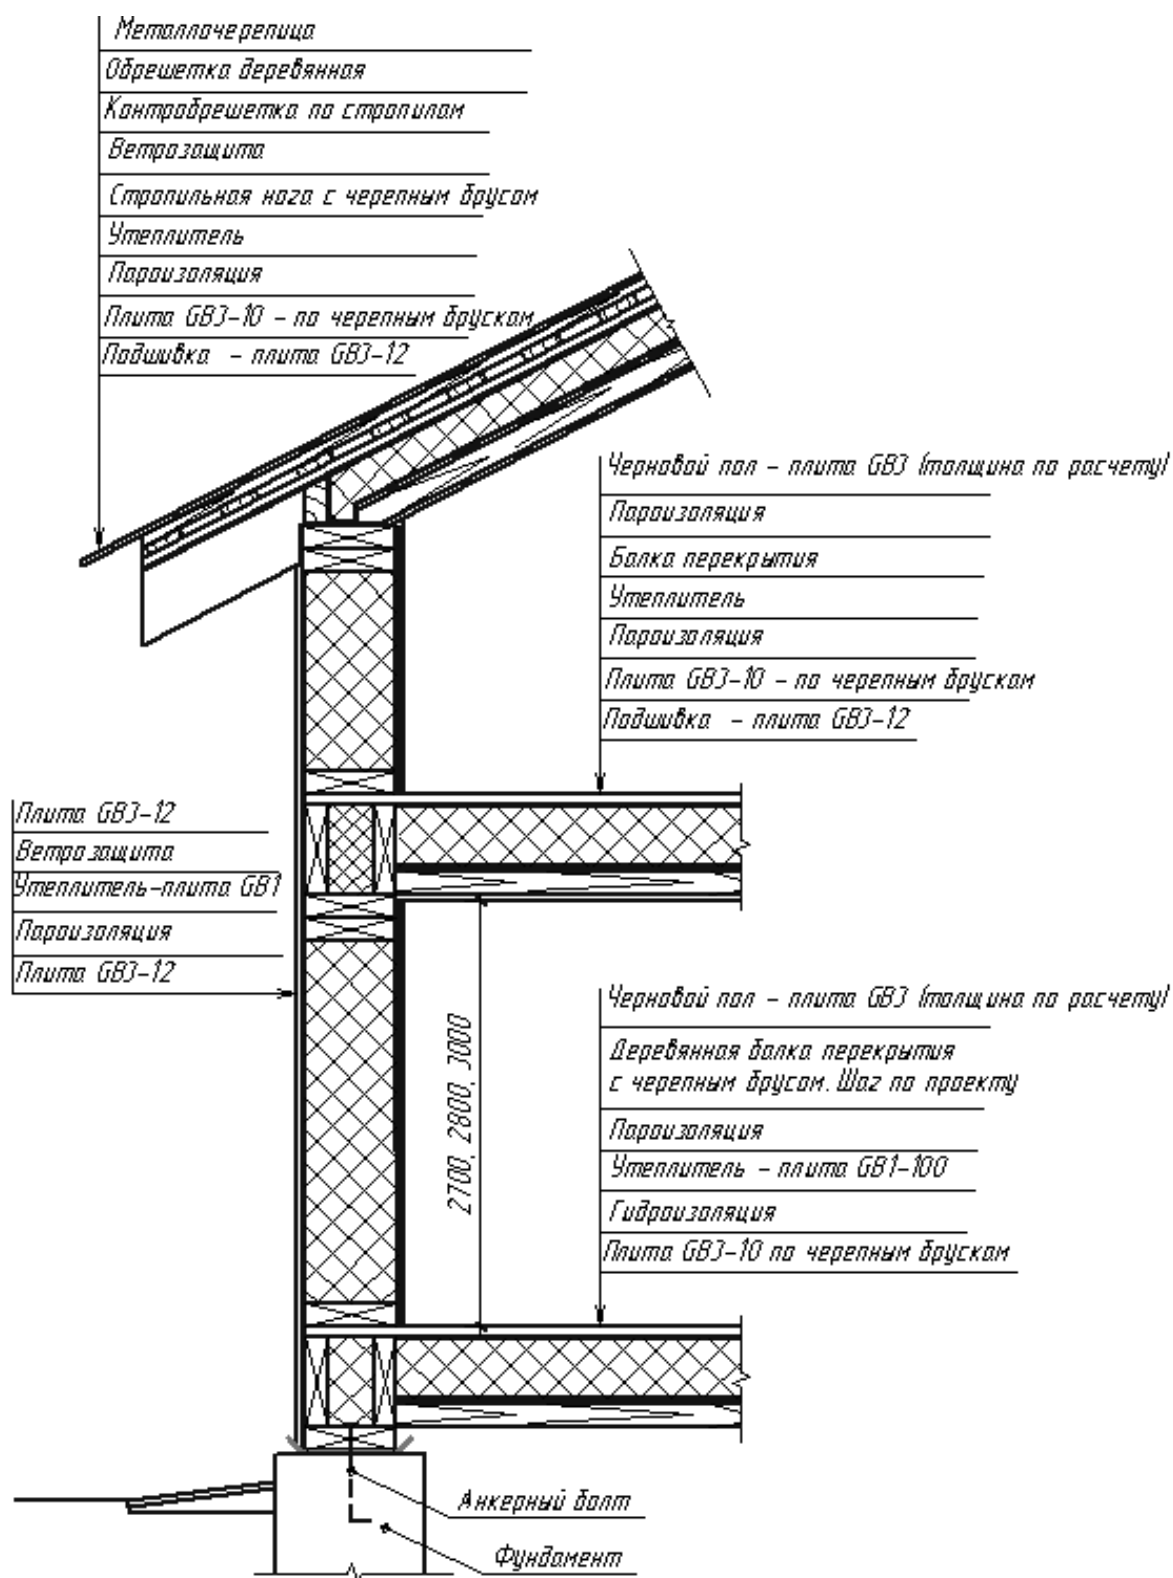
Разрез каркасного дома «GREEN HOUSE®»
